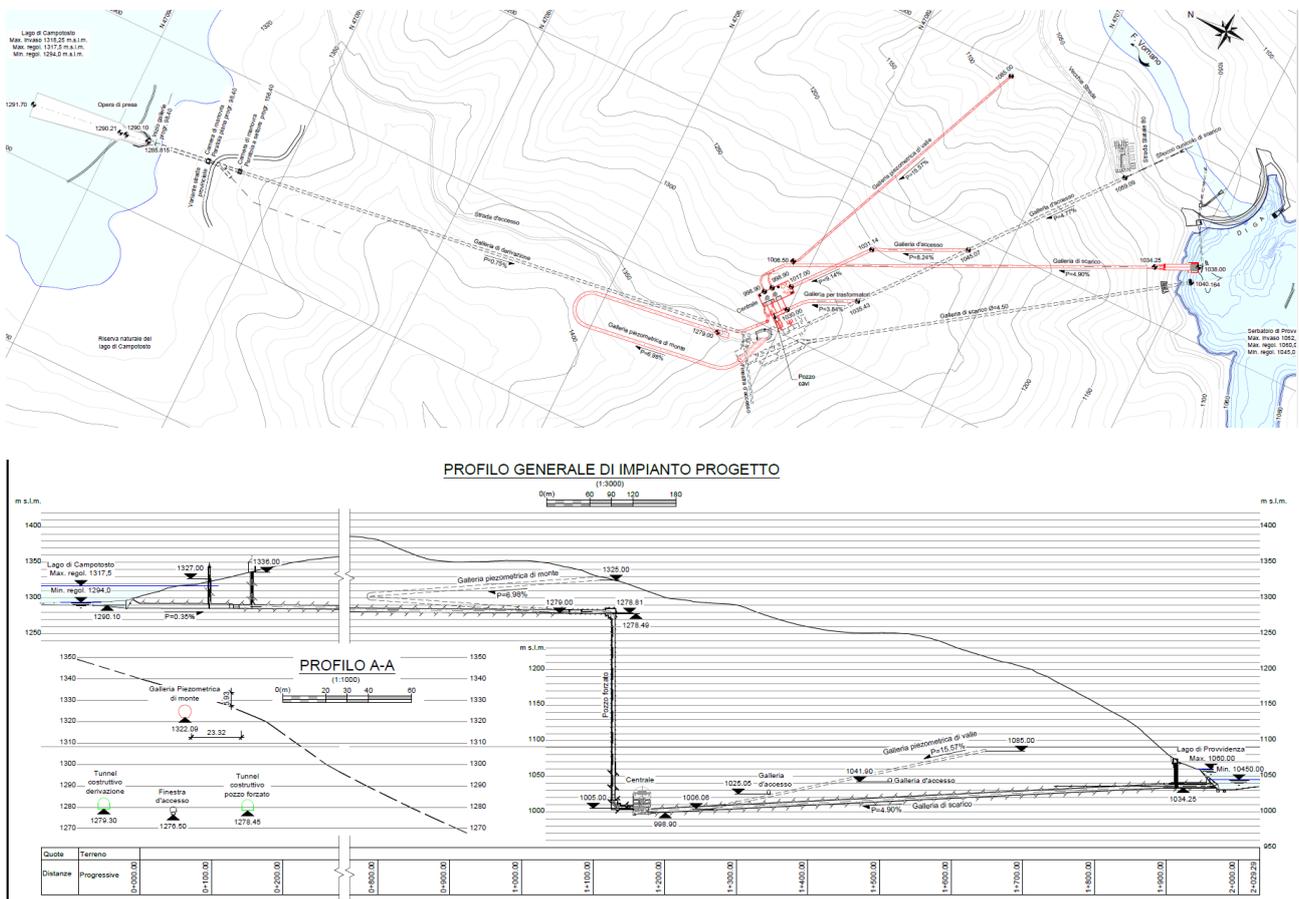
Estratto cartografica da planimetria e profilo generale dell'impianto in progetto
